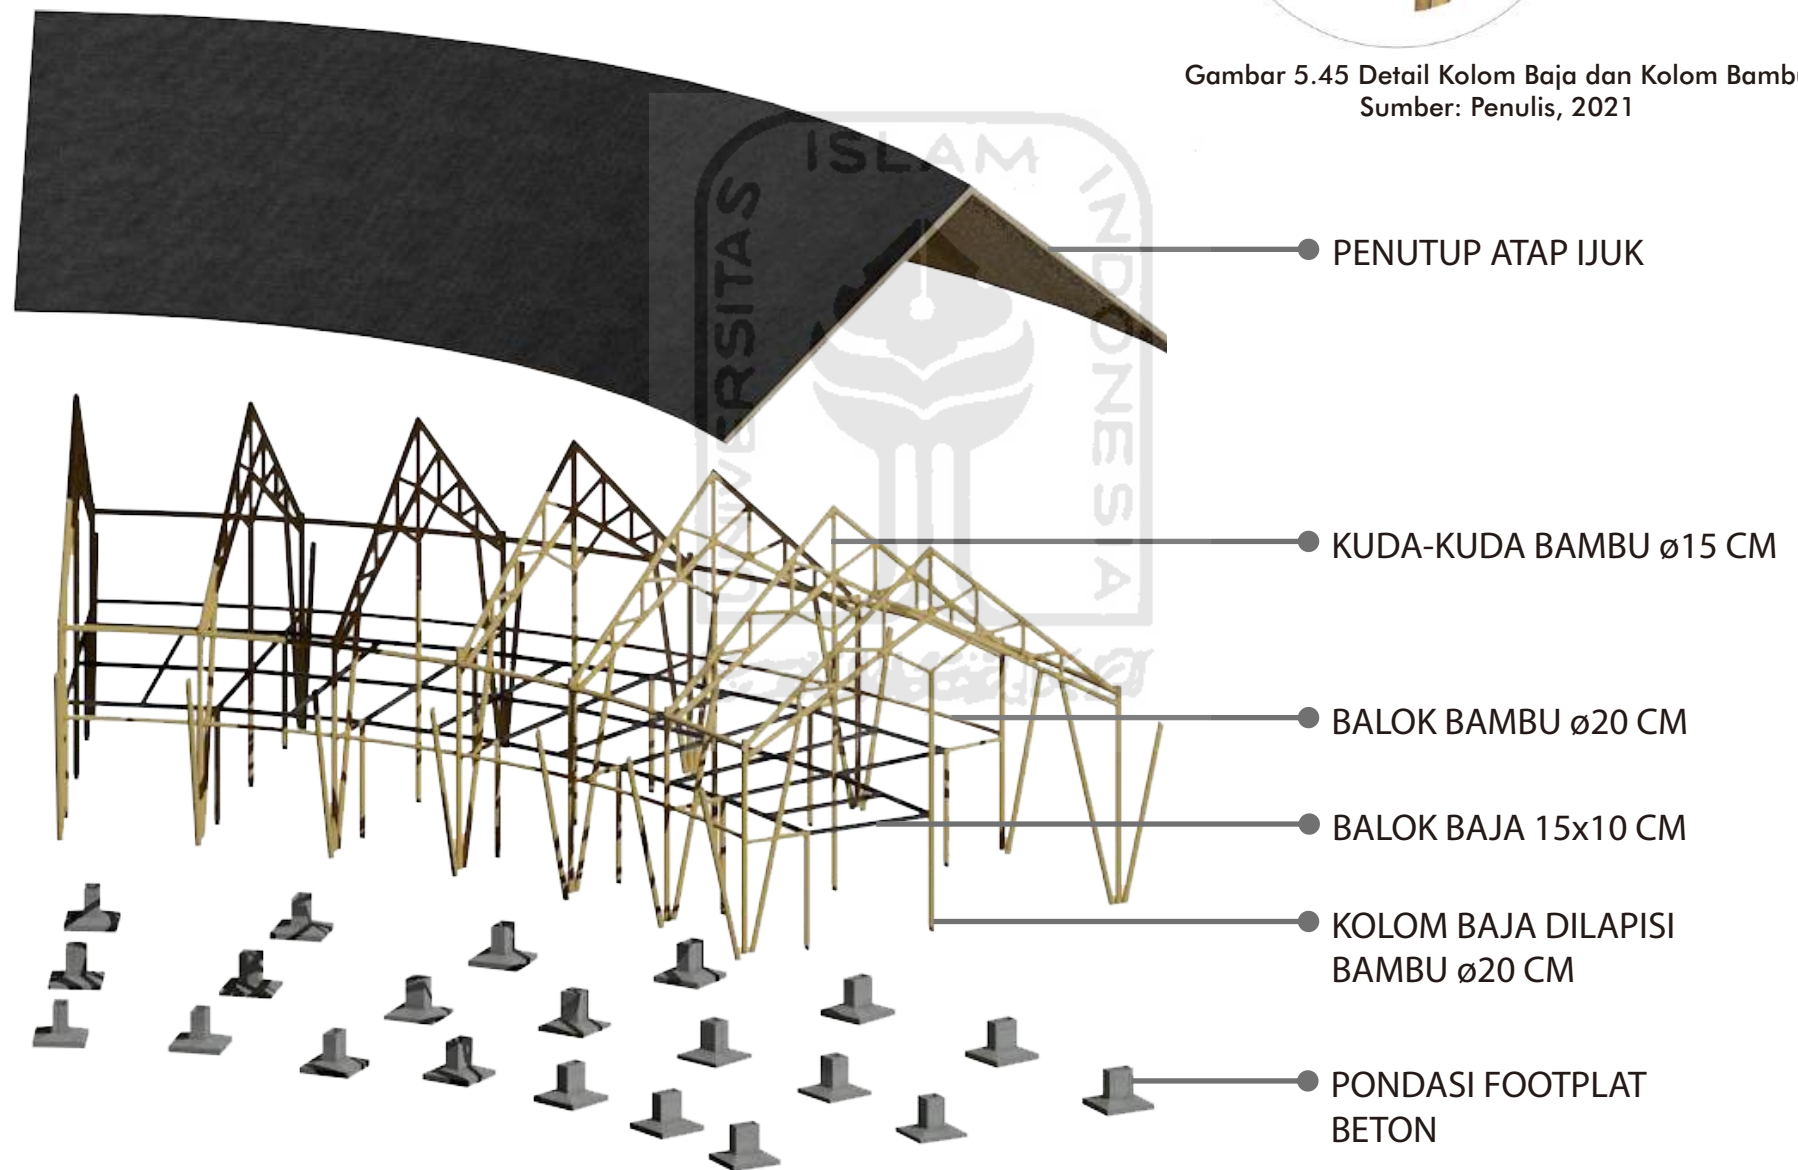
Rancangan Sistem Struktur 1 Lantai
